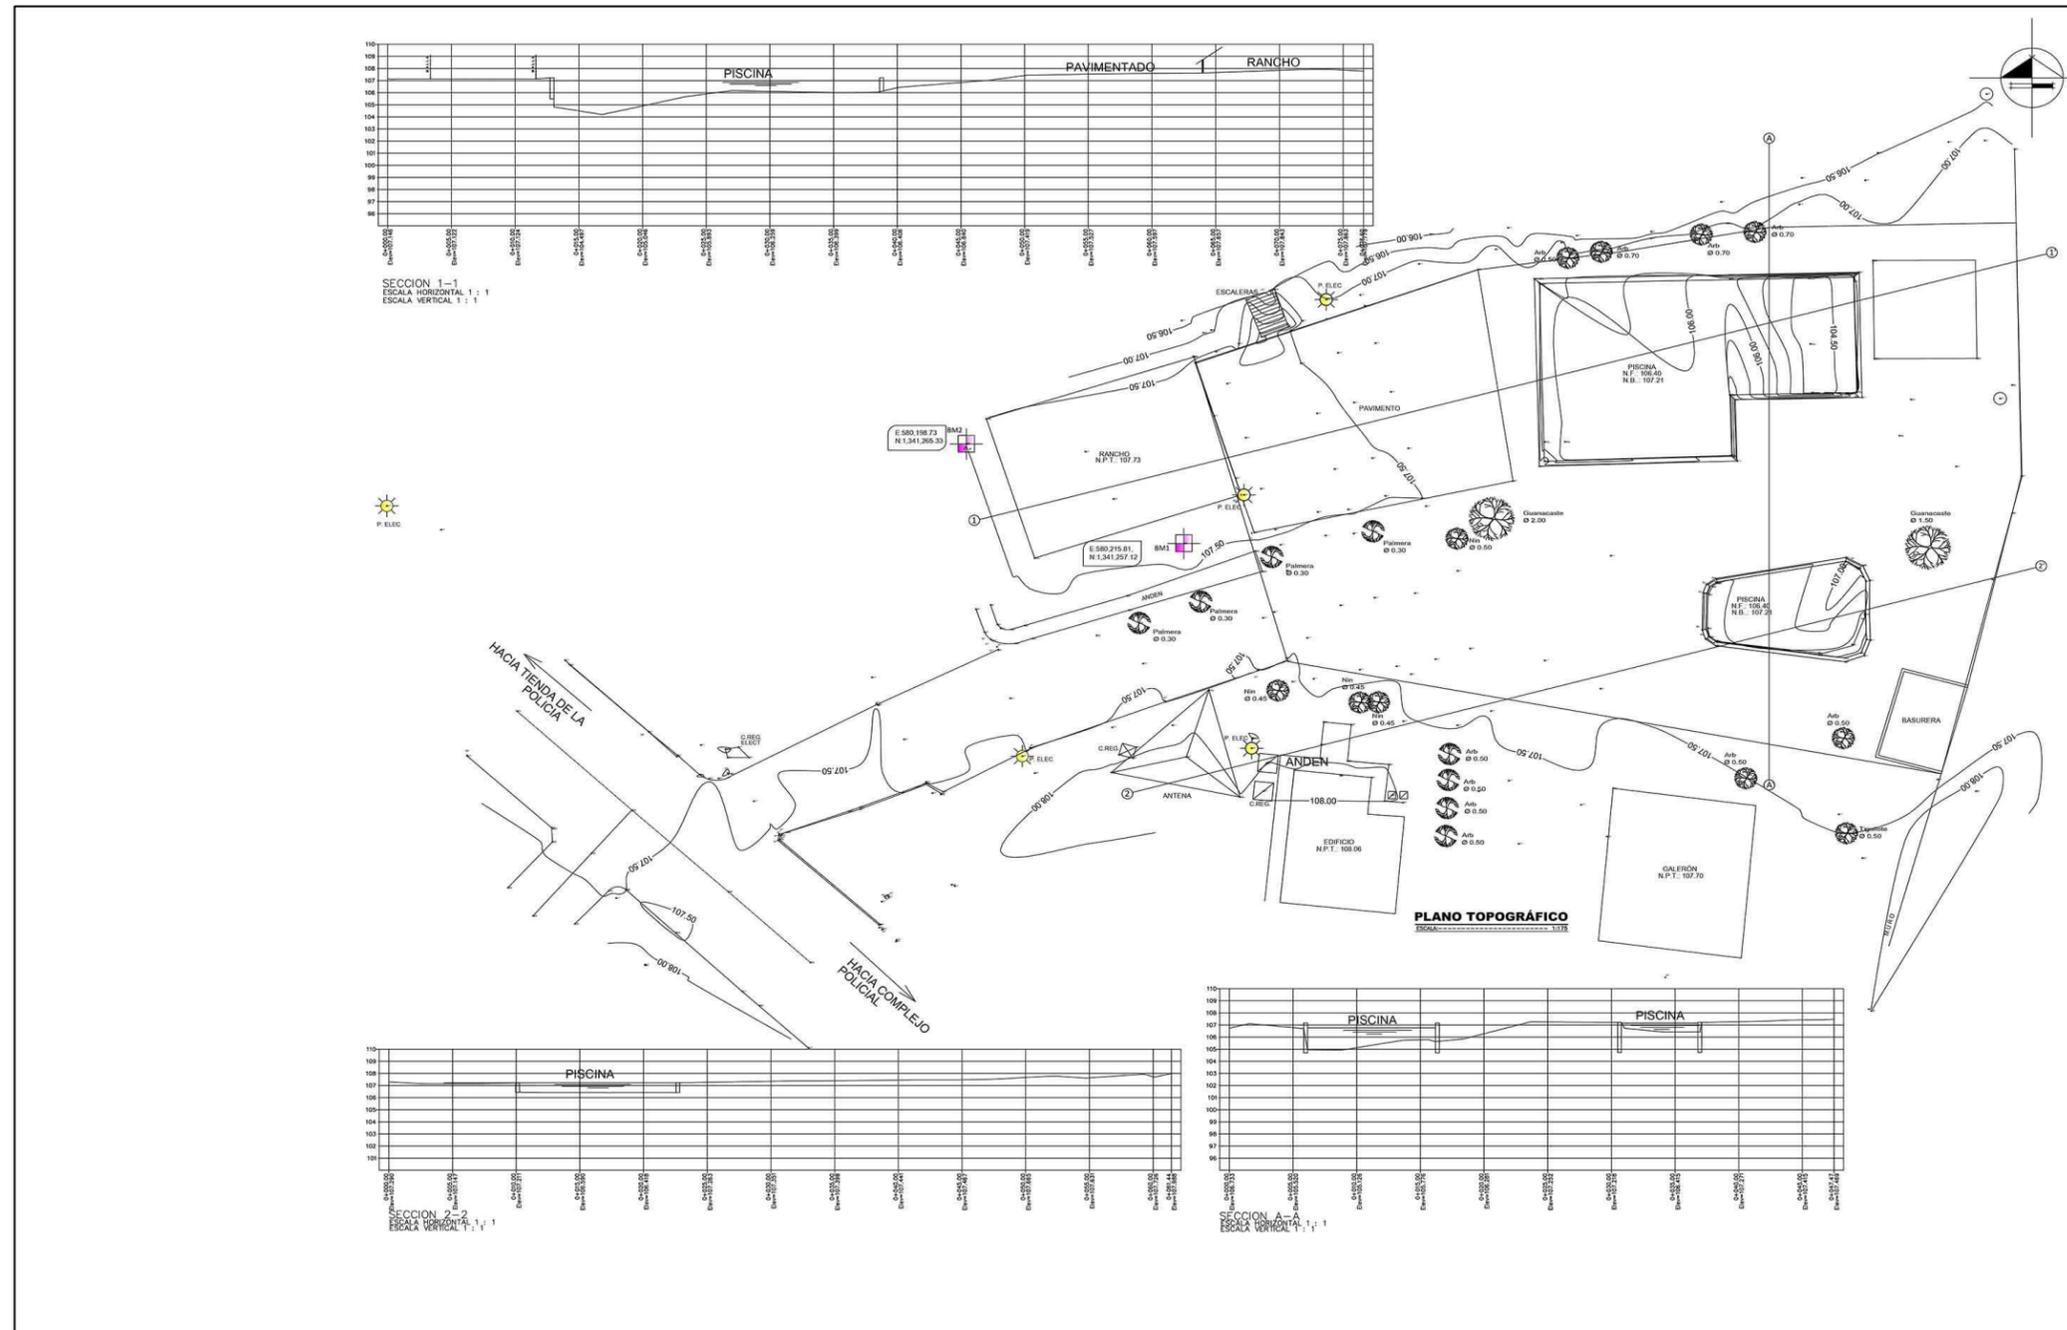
Plano topografico del proyecto de Cancha Multiusos Faustino Ruiz, elaborado por la Practicante Fuente: Báez, J. (2021) Supervisión: Arq. Engels Espinoza
